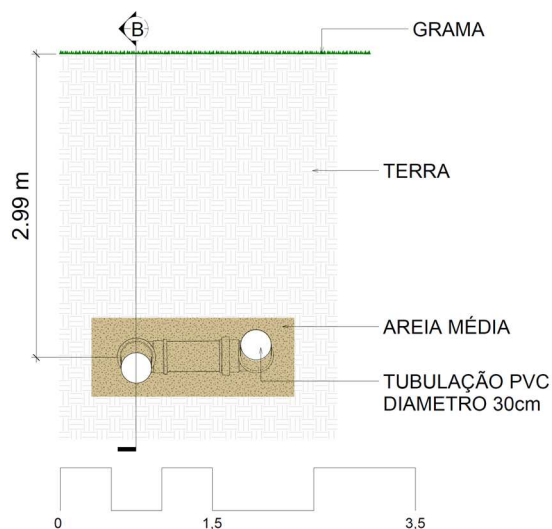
Planta baixa Trocador de Calor Terra-Ar
